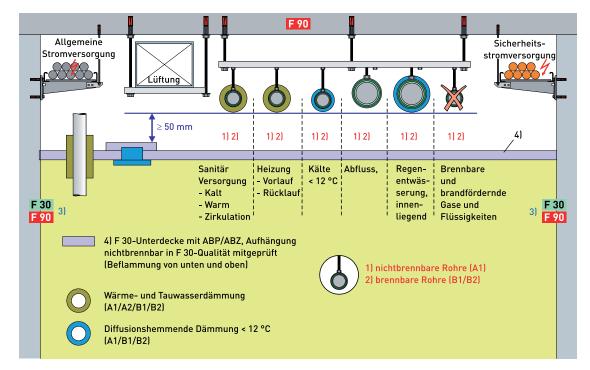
Leitungstrassen oberhalb einer F 30 Unterdecke (Nachweis der Brandbeanspruchung von oben und unten erforderlich).
